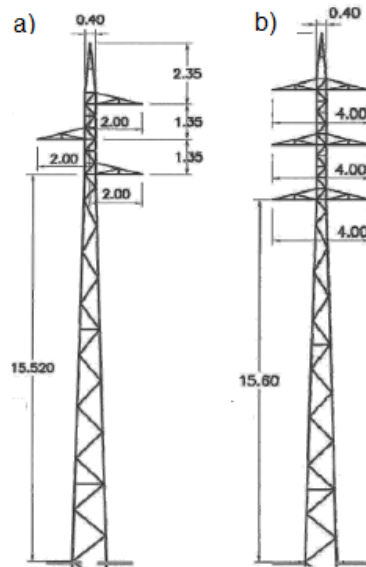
Silhueta de um apoio com disposição dos condutores em a) galhardete, b) esteira, adaptado de [19]
